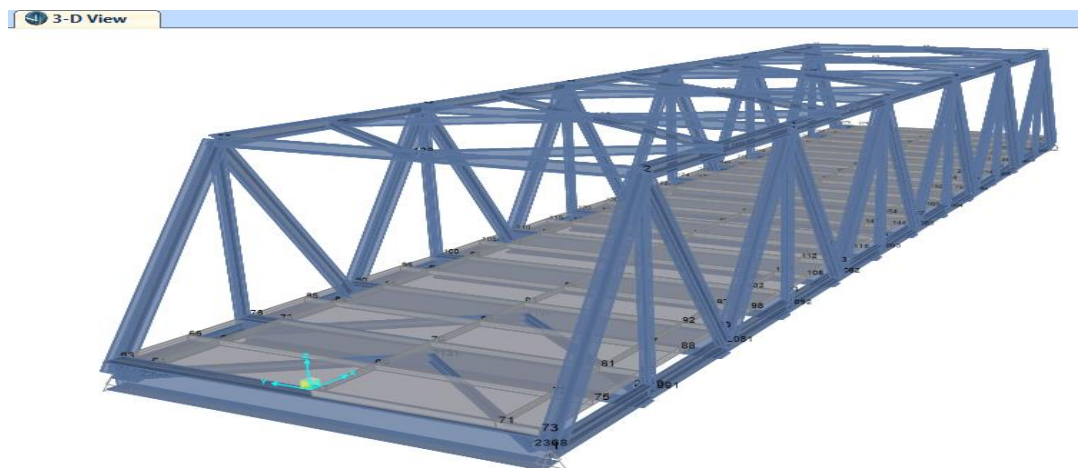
Vista en 3D de la armadura metálica final + losa de concreto armado
